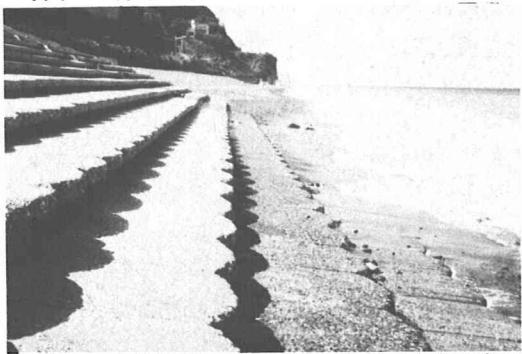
青海海岸の緩傾斜堤の状況(中央西寄り)
